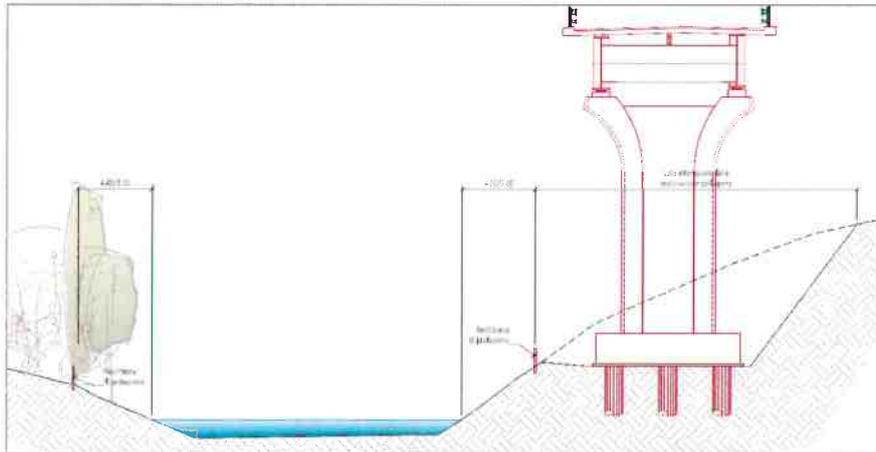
Sezione tipo che rappresenta la fascia di protezione lungo le sponde del fiume.
